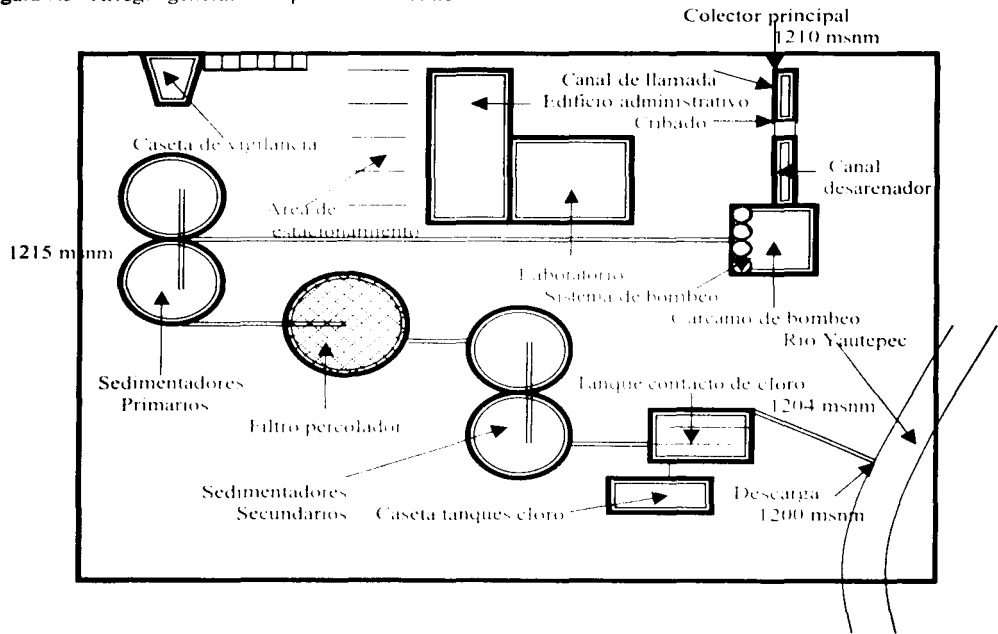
Perfil de distribución de la planta de tratamiento.
